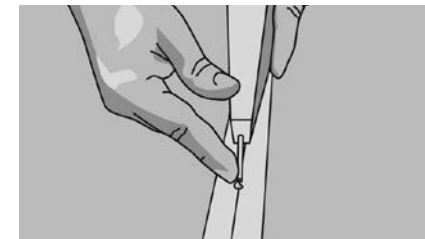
Всегда работайте двумя руками! Одной рукой держите тюбик, указательный палец второй руки положите на сопло. Вдавите иглу глубоко в шов так, чтобы холодная сварка попала в образовавшееся отверстие.
